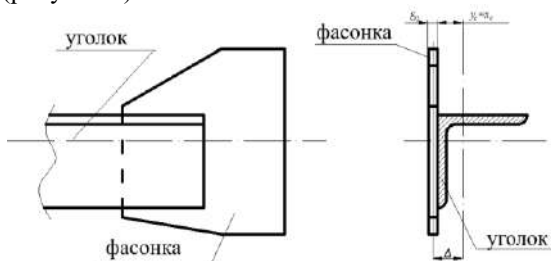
Схема известной конструкции соединения уголка с фанонкой [1]
